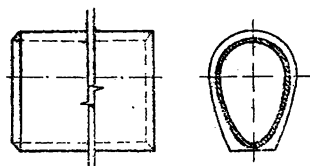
Tub de beton cu secțiune ovoidală.
